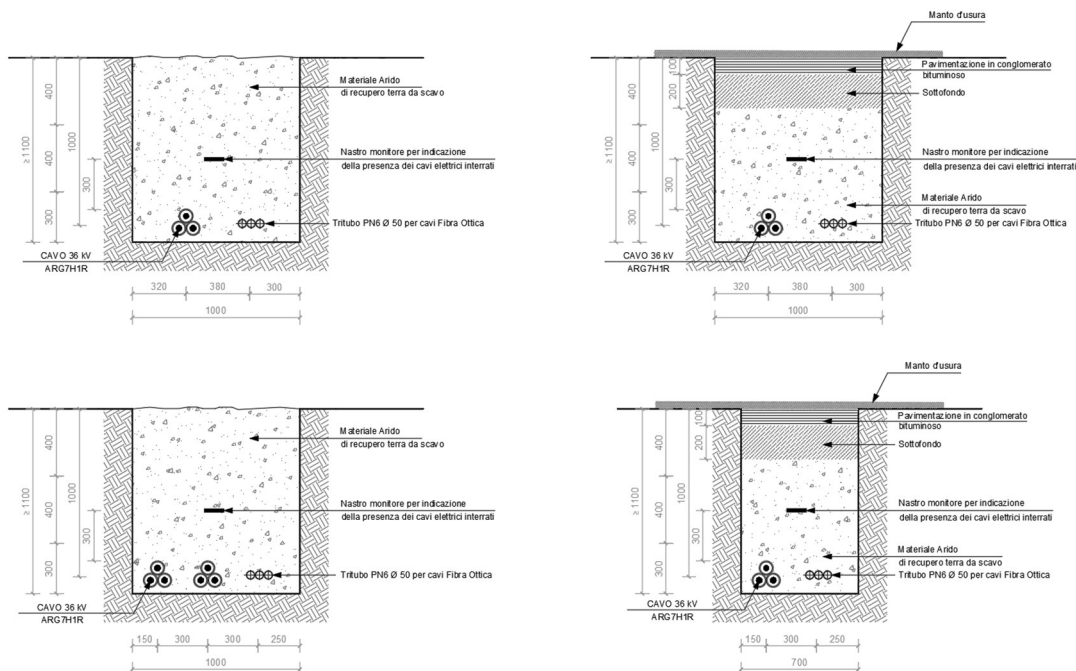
Tipico modalità di posa cavidotto a 36 kV di collegamento impianto FV – SE RTN
